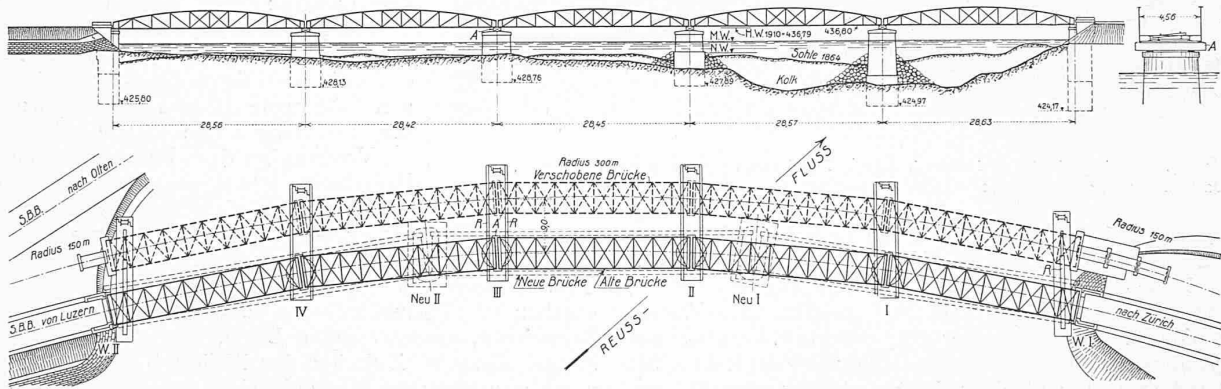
Ansicht, Querschnitt und Grundriss der alten Brücke, Grundriss der verschobenen und der neuen Brücke. — Masstab 1:1000.
